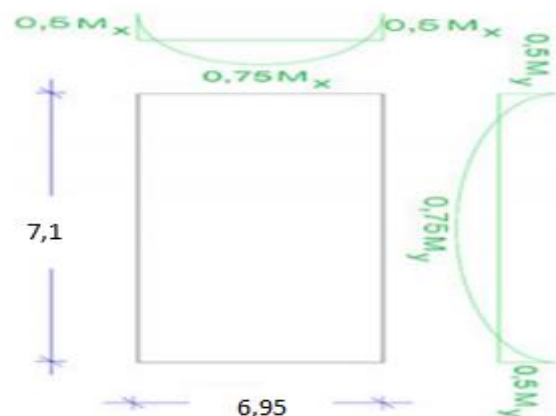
Schéma du panneau de la dalle appuyée sur 4 coté.
